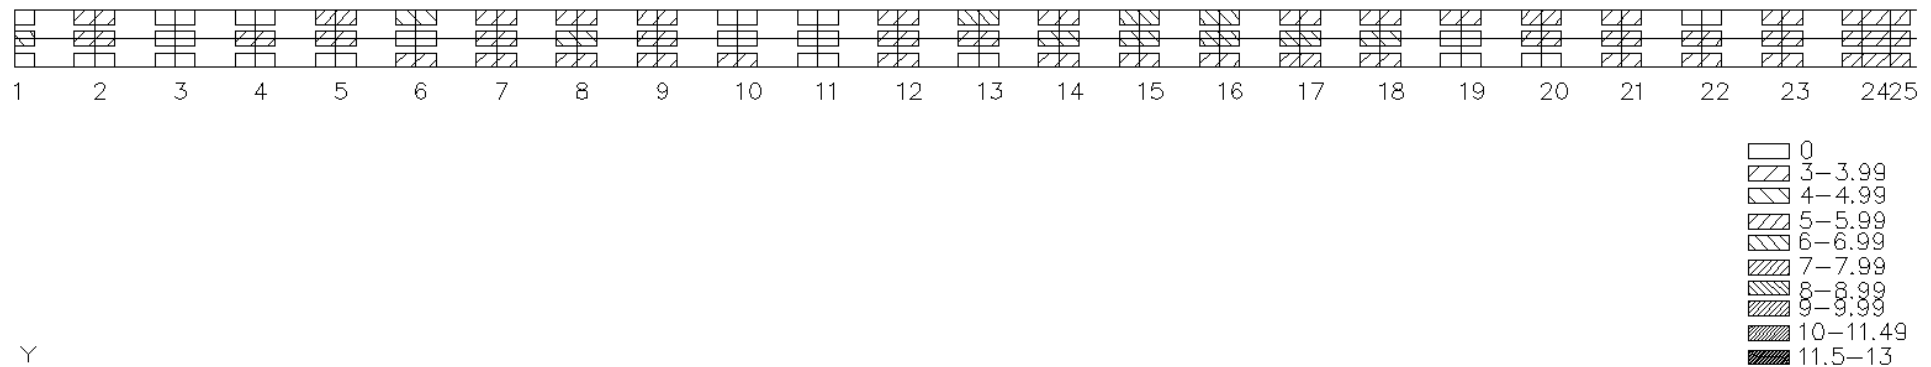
Ausgleichsdicken bei Tangenten und quadratischen Parabeln und Verfahrensplan Typ V, Grundriss, Stationen 1-25
